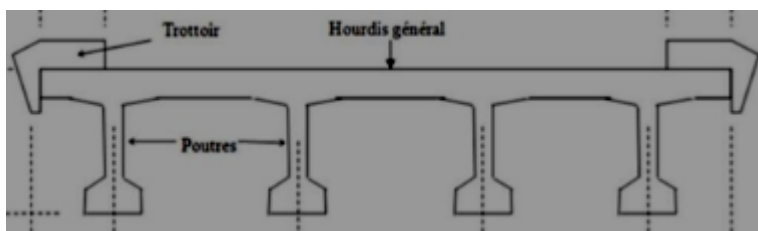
Coupe transversale d'un pont à poutres préfabriquées
